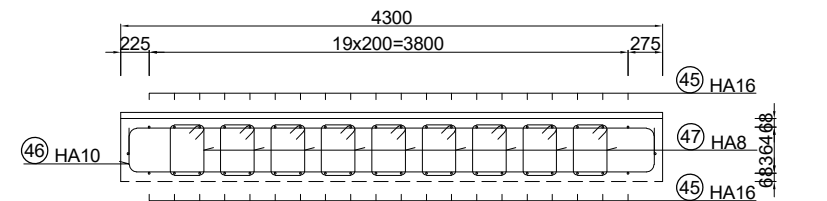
DETAIL ZONE D'APPUI / BEARING SURFACE DETAIL A3: 1/60 ; A1:1/30
